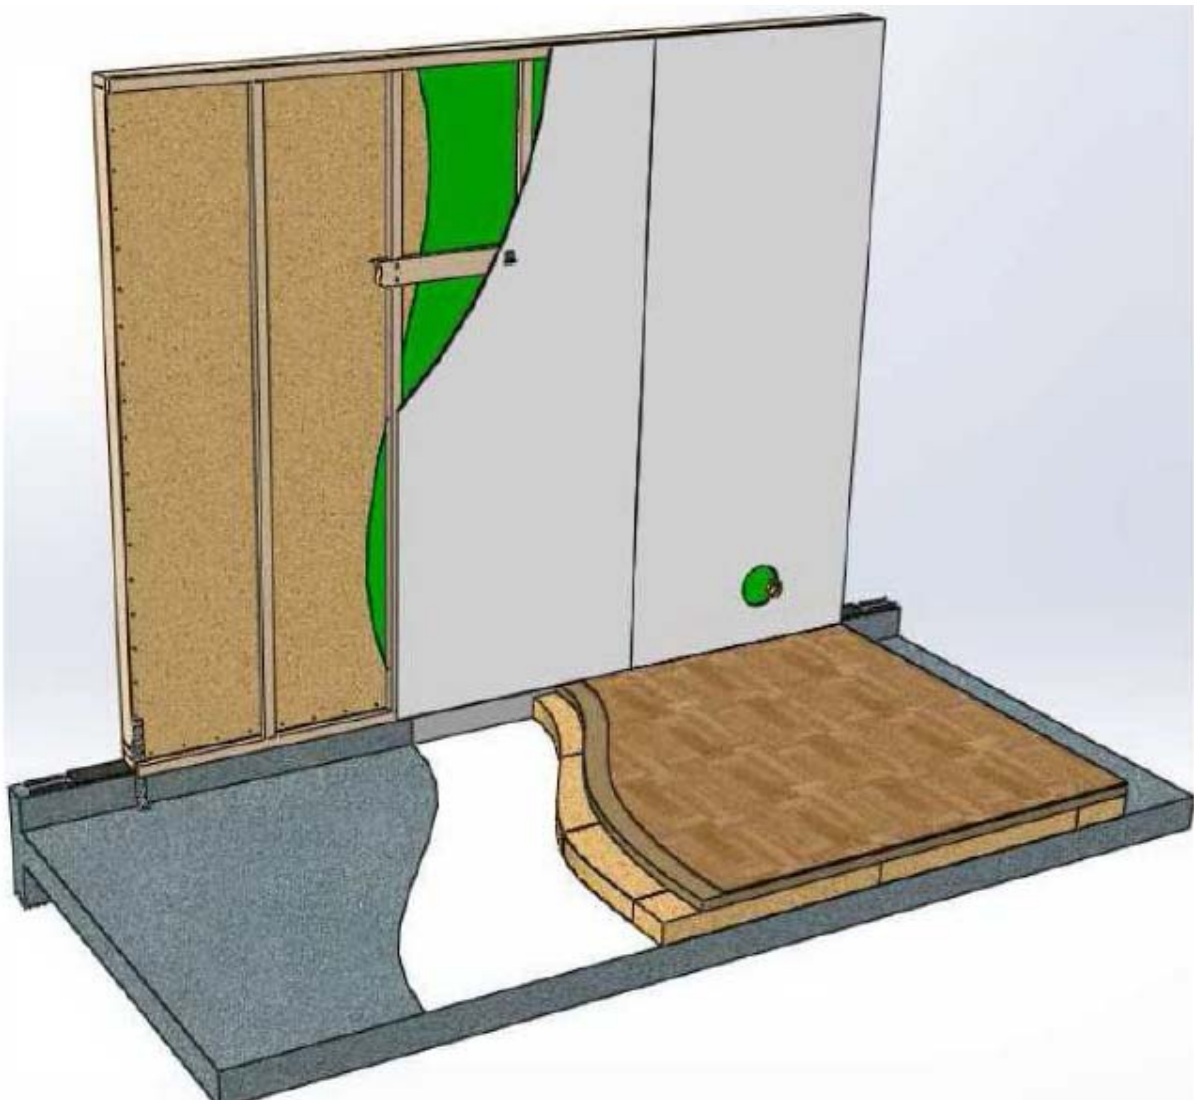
Mur avec revêtement intérieur sur ossature secondaire bois rapportée verticalement
